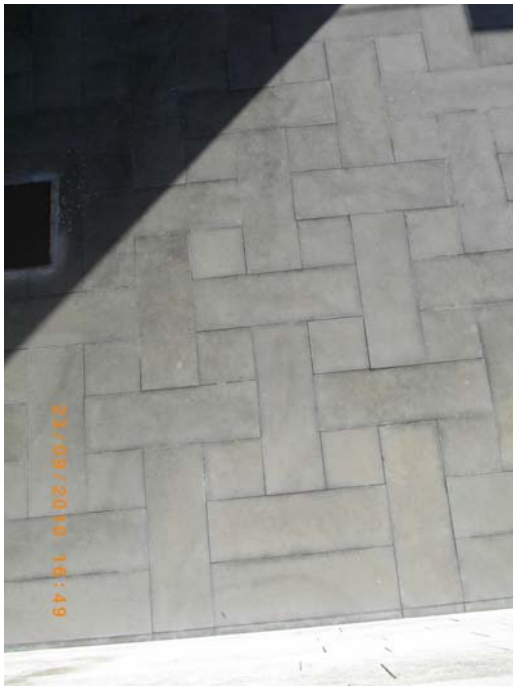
Cortile di Palazzo "Albini" (Interventi B1-B2) – Pavimentazione
